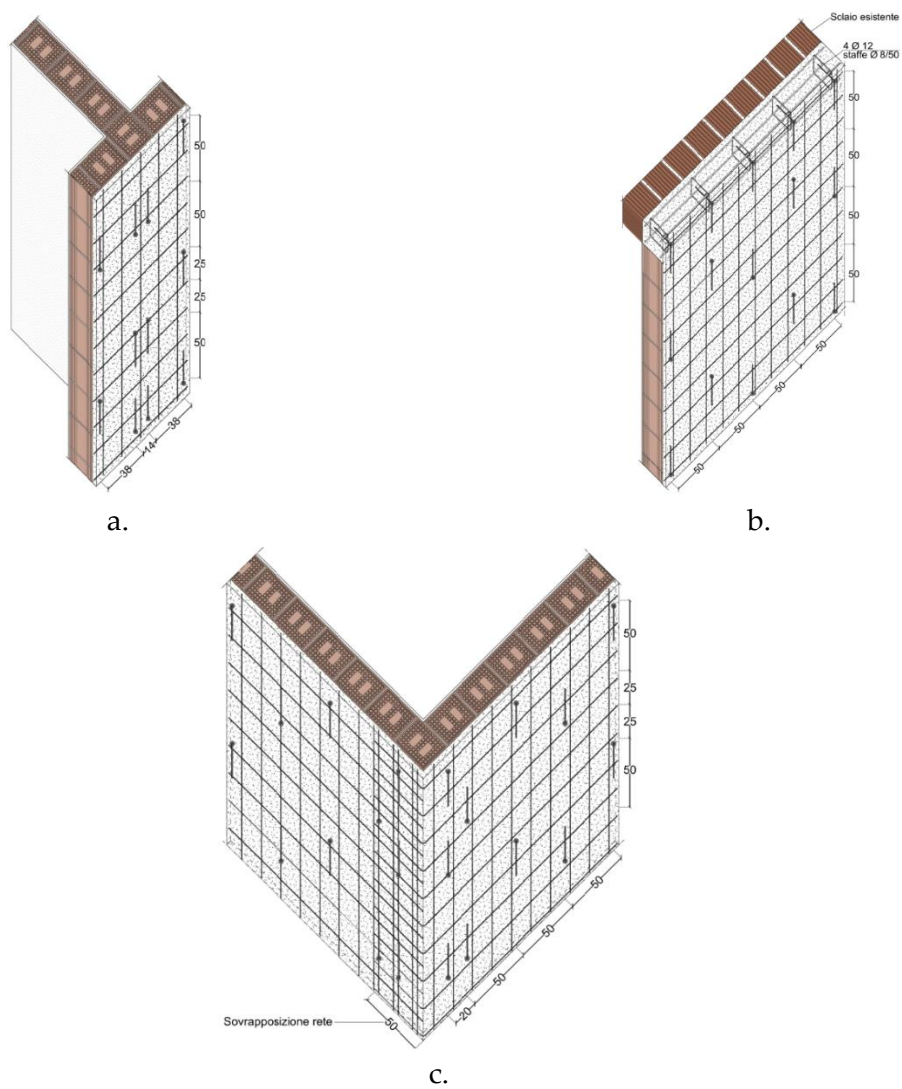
Schema assonometrico connessione: a) martelli murari; b) ultimo solaio; c) cantonali.
